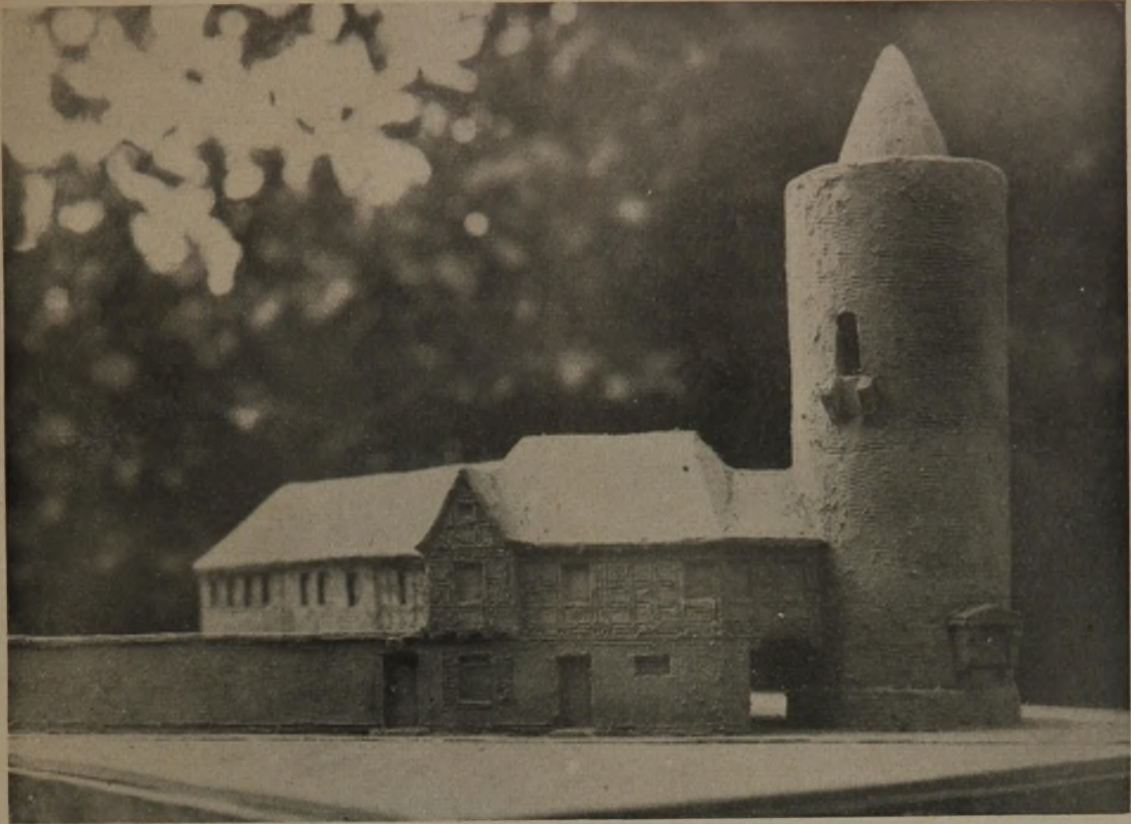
Anbau mit Durchgang am Plauer Torturm.
